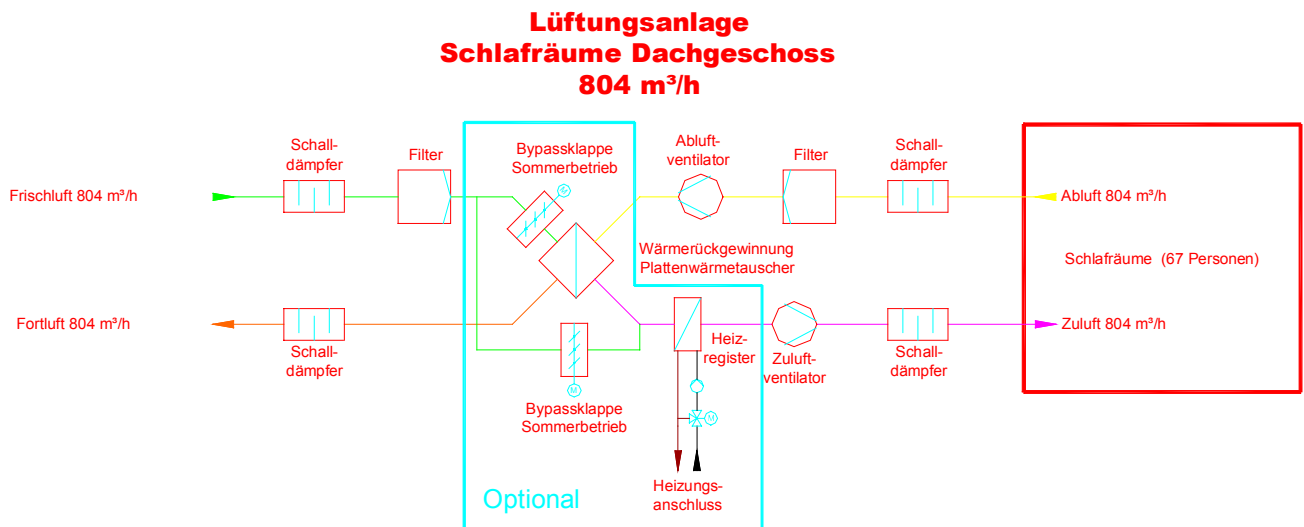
Lüftungsschema - Lüftungsgerät Schlafräume Dachgeschoss
